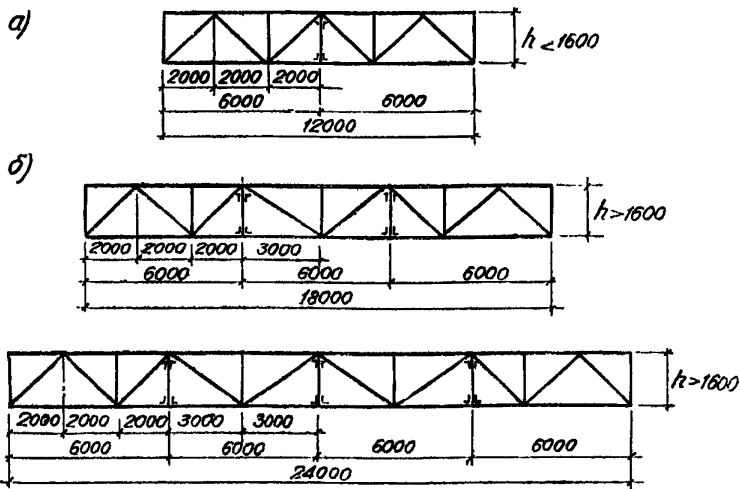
Примеры разбивки решетки подстропильных ферм в зданиях со смешанным каркасом
